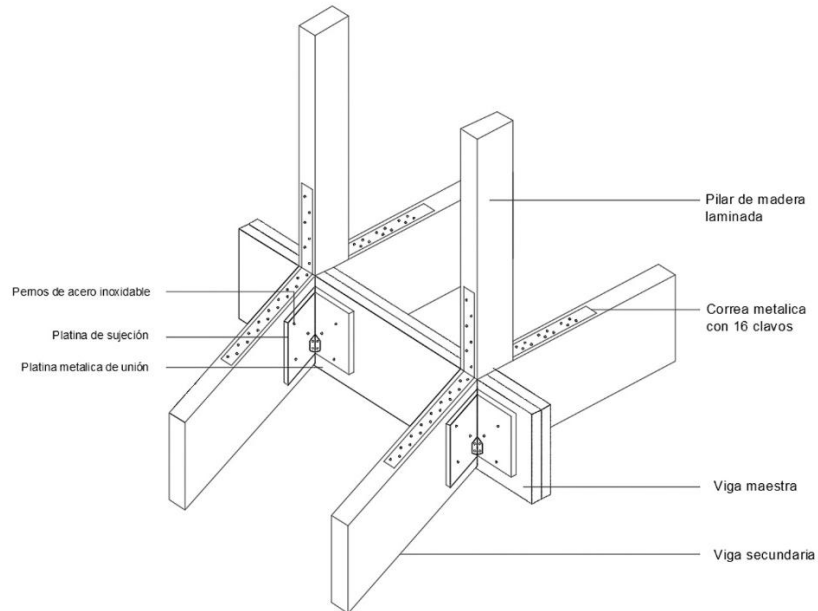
Detalle constructivo unión de vigas de madera laminada
